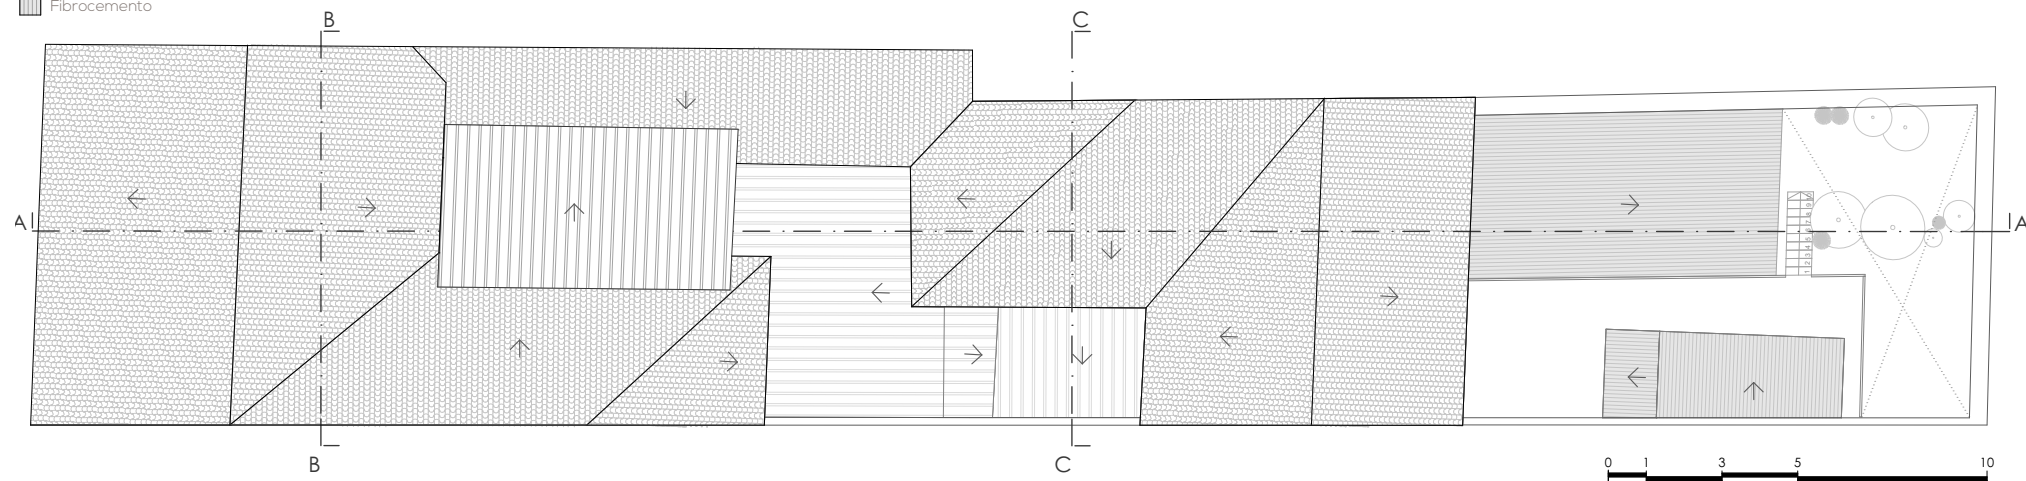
Planta de cubiertas | Caso de estudio 2, Vivienda Berrezueta.
